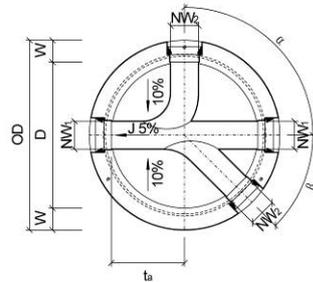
Grundriss CRENO Normschachtboden Typ 4
